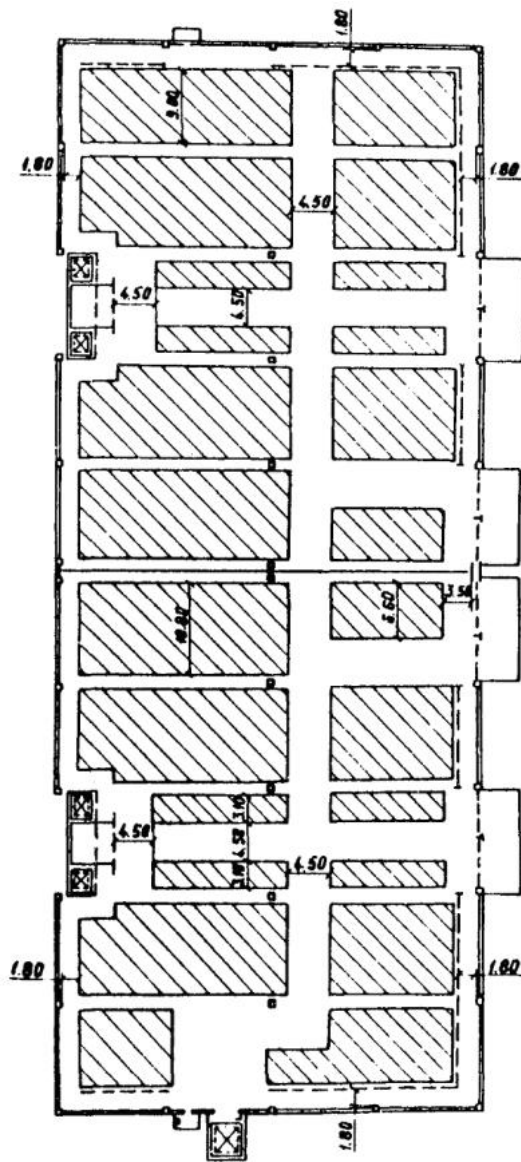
Пример схемы допускаемых нагрузок для крытого грузового склада. План загрузки 2-го этажа трехэтажного склада с допускаемой нагрузкой 20 кН/м² (2 тс/м²).
